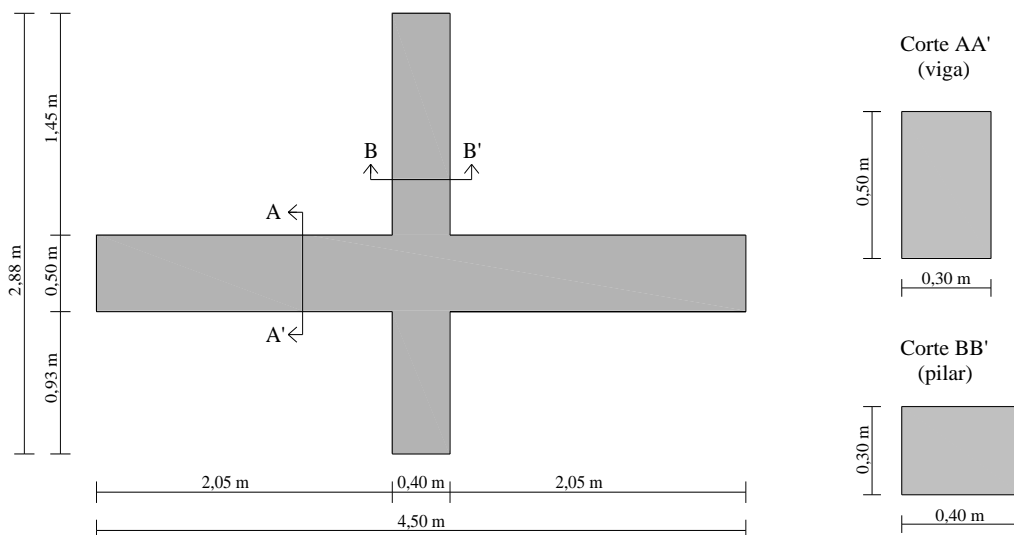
Geometria e secções transversais dos provetes nós viga-pilar.
